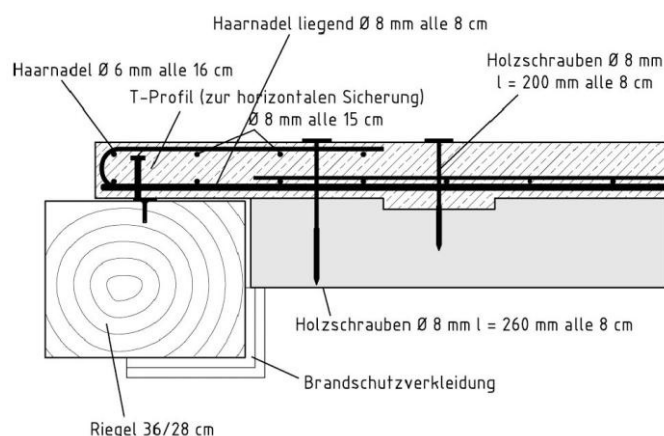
Auflagerdetail HBV-Decke mit Lastabtragung über die Betonplatte [27]
